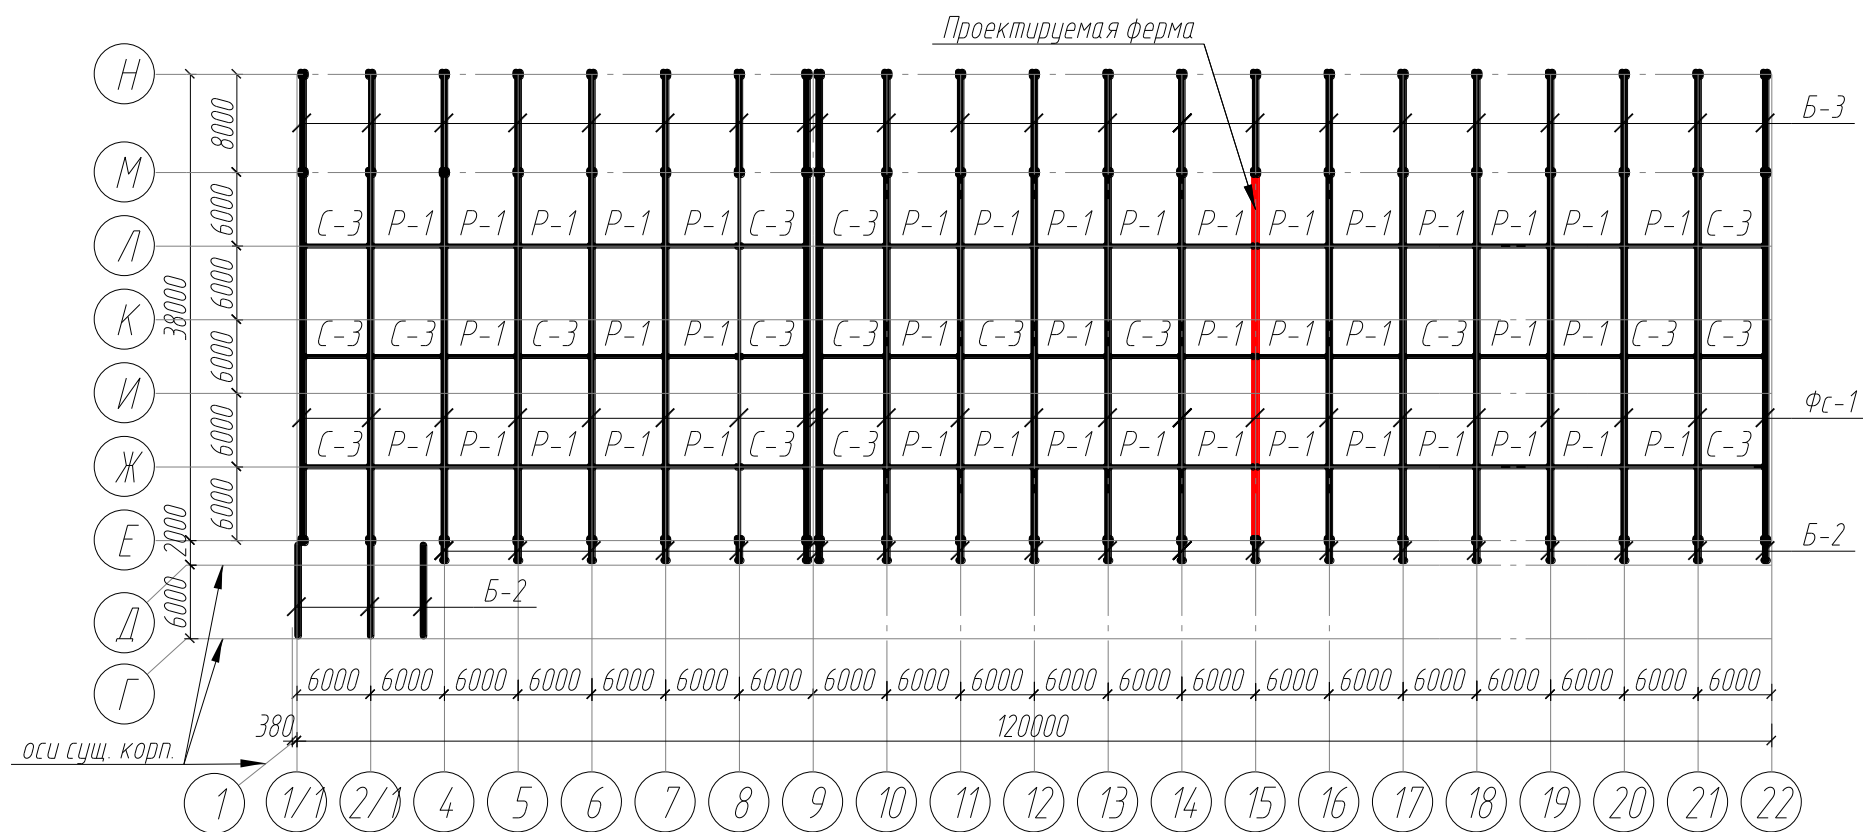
Схема связей и распорок по нижнем поясам ферм
